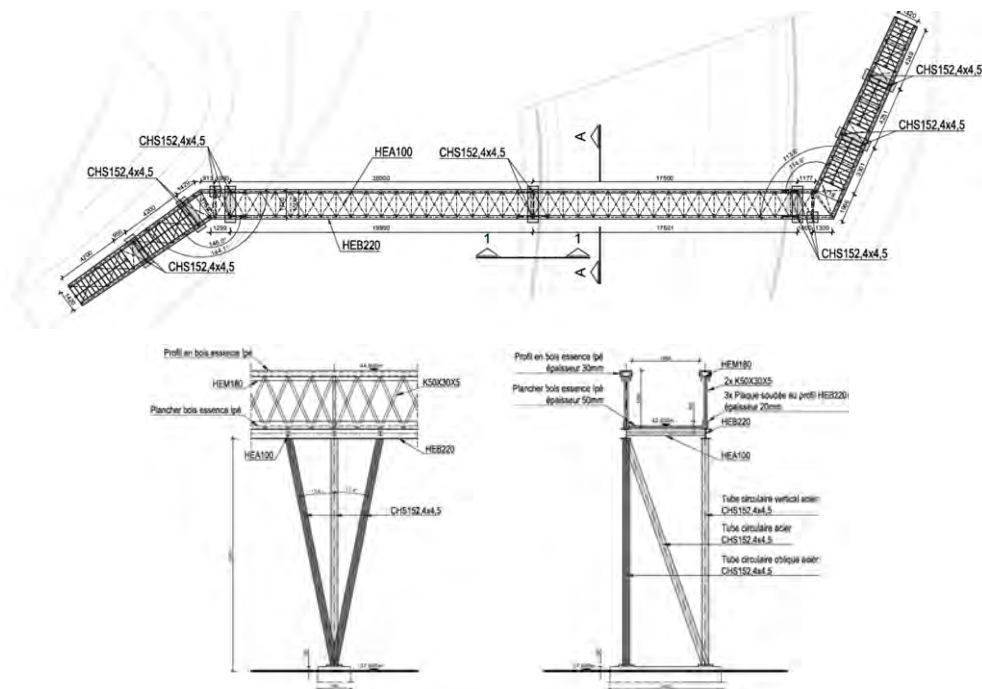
Plan, élévation et coupe de la passerelle (BMN, 2017)
